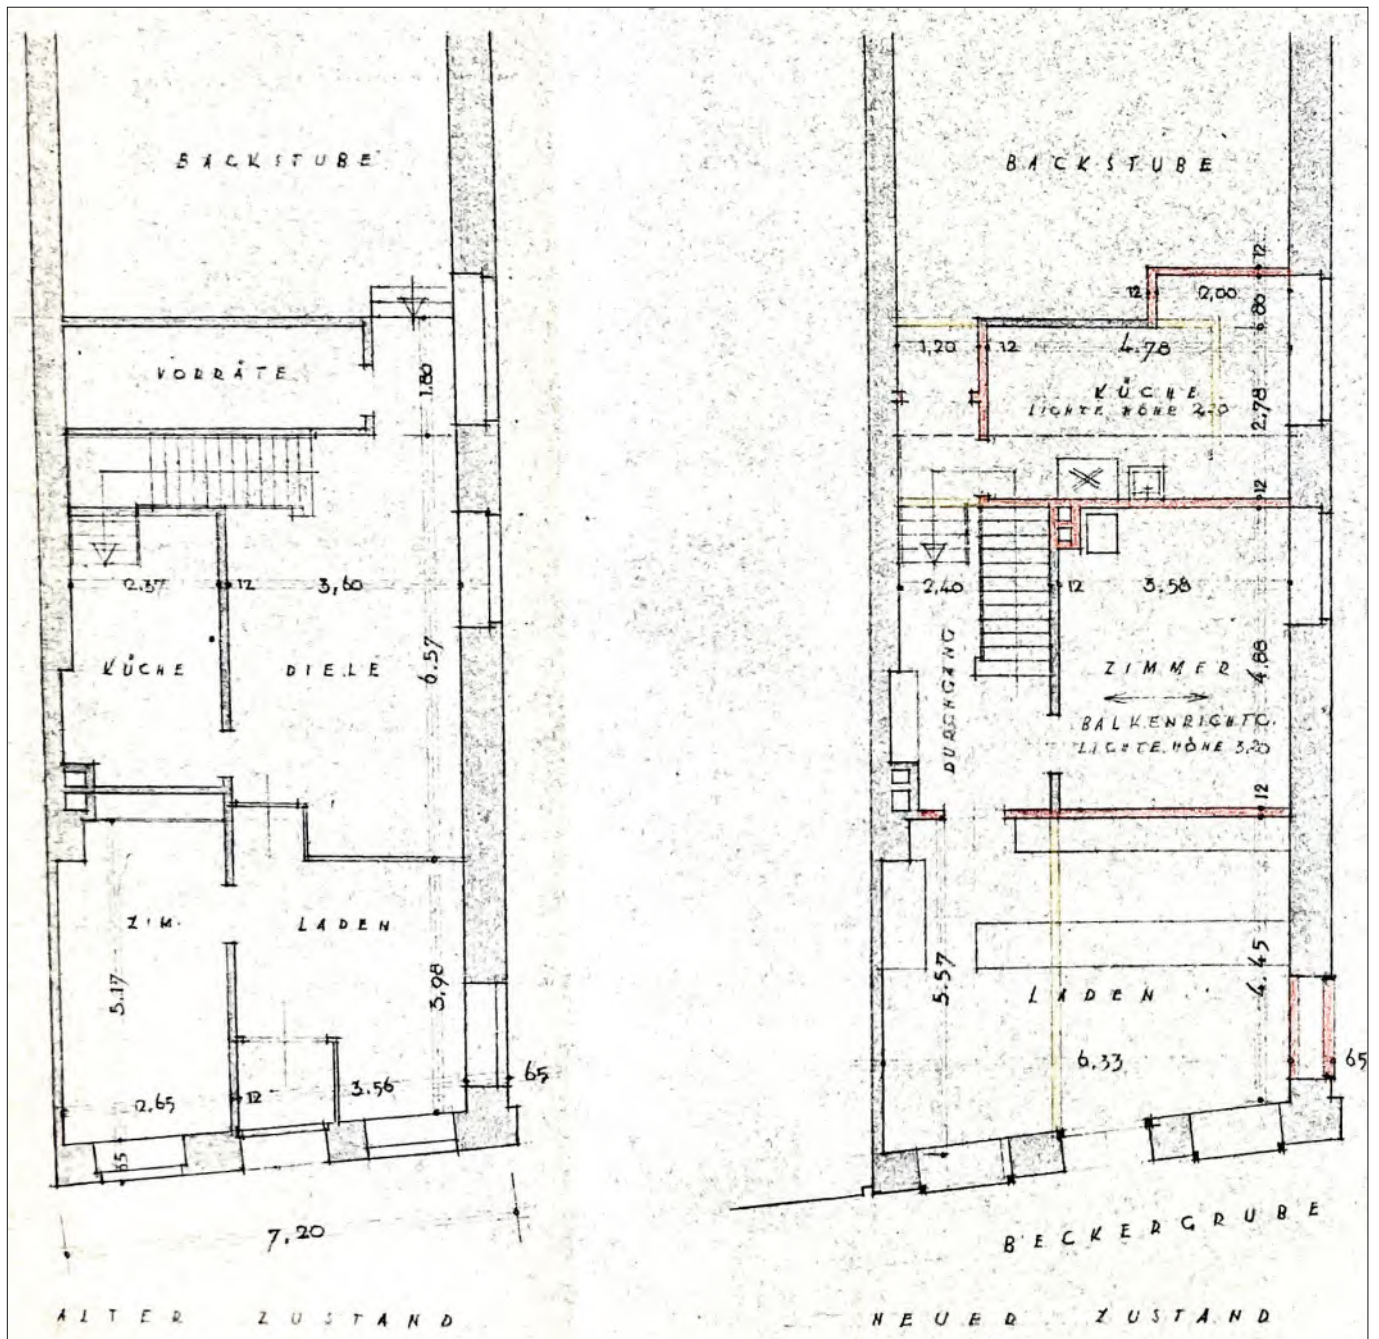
Lübeck, Beckergarbe 76, Grundrissänderungen im Vorderhaus, 1946 – HL/Bauaktenarchiv.
